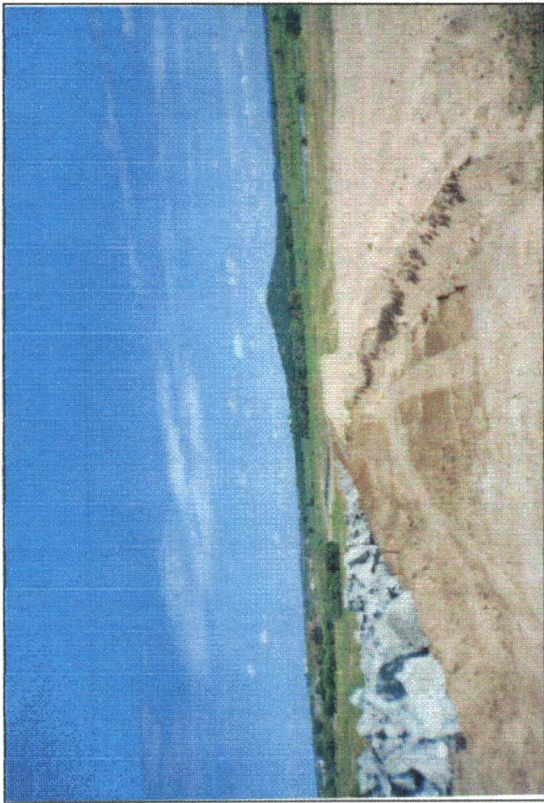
Preparação do terreno para construção do rockfill.
